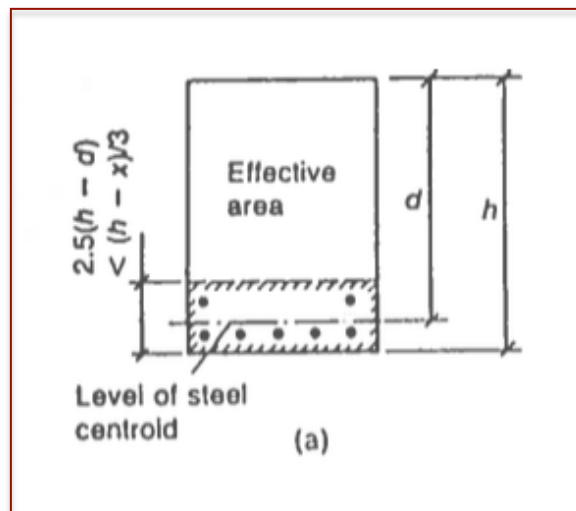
Cálculo da área de betão efectiva para vigas de betão armado [5].
